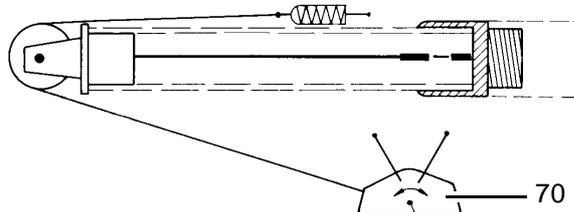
Poussée du GRUNDOMAT P par le train de tubes à entraîner
